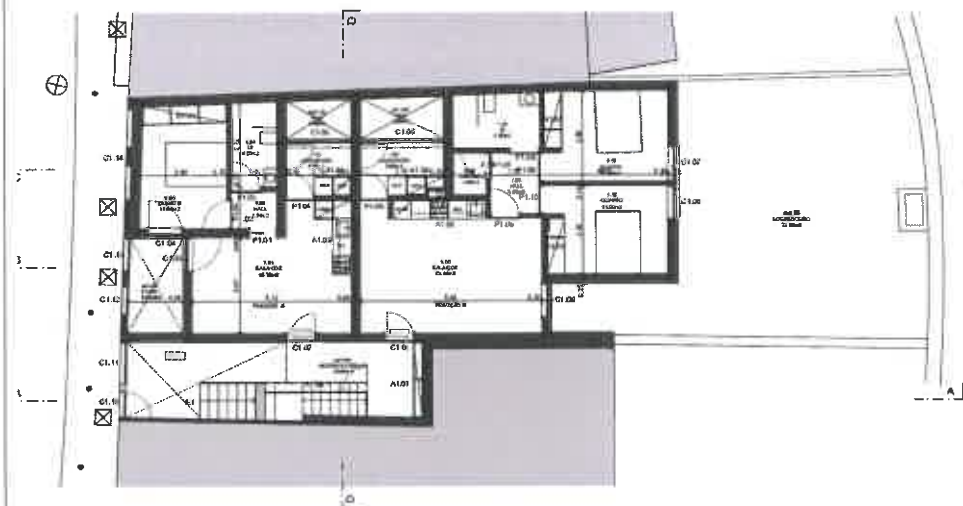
Planta Tipo Piso 1 e 2 (semelhantes)
